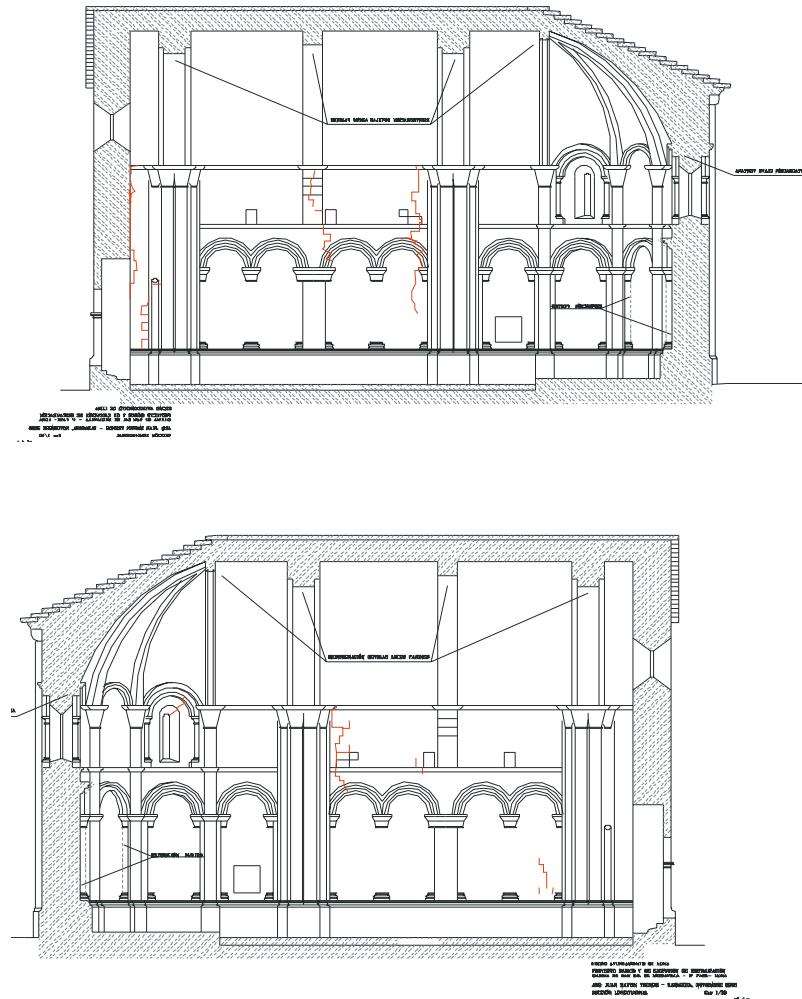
Fisuras detectadas en la sección longitudinal.
